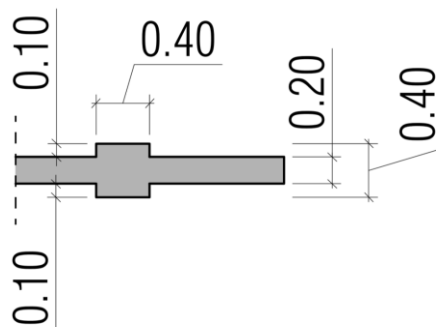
Representação em corte da localização da laje junto com a viga.
